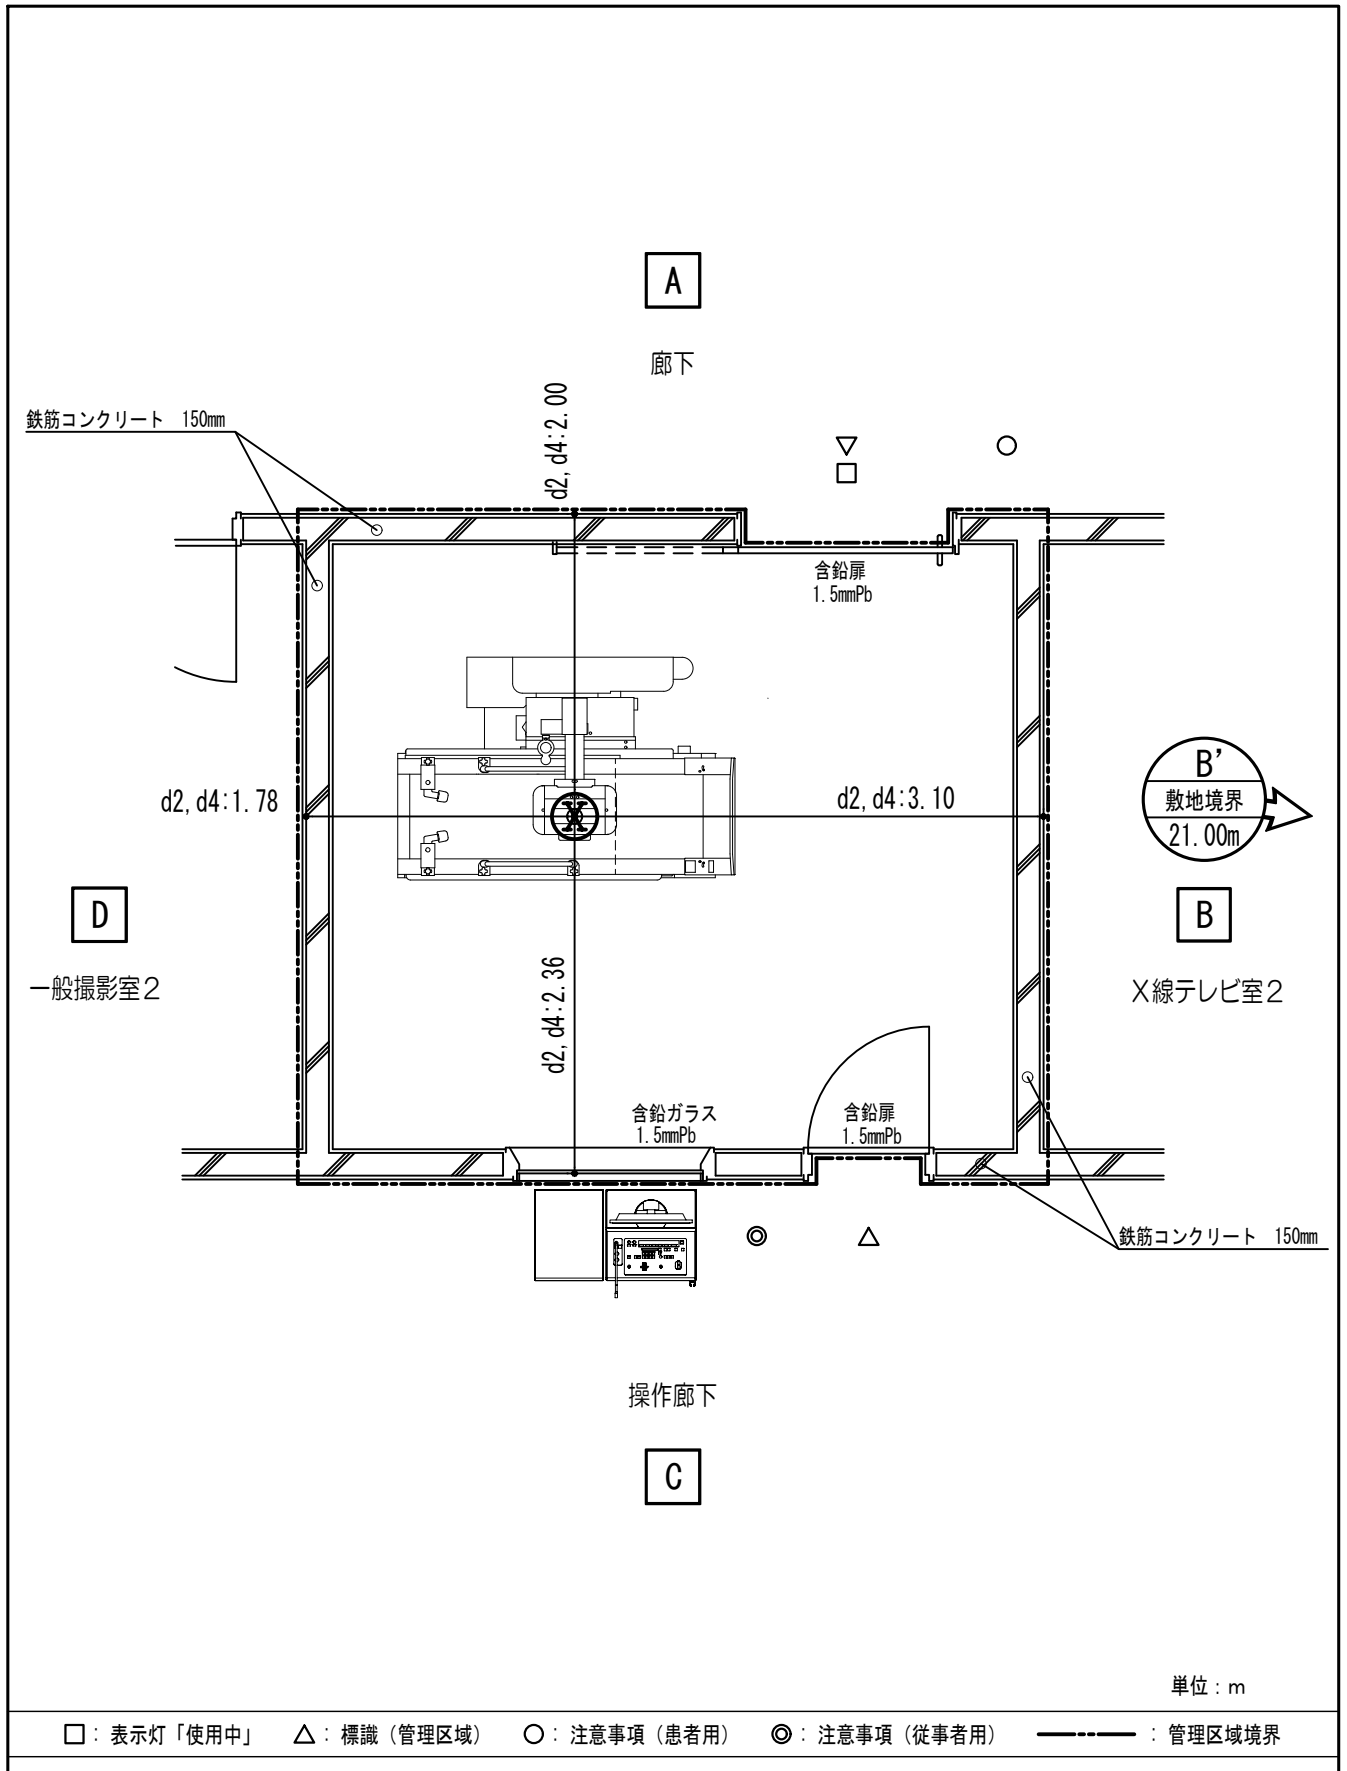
X線テレビ室 臥位 透視・撮影 平面図
